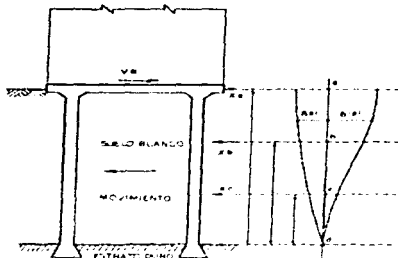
ESTRUCTURA DE CIMENTACIÓN SOBRE PILAS, SUELO PARA PLANTAS CONTIGUAS
